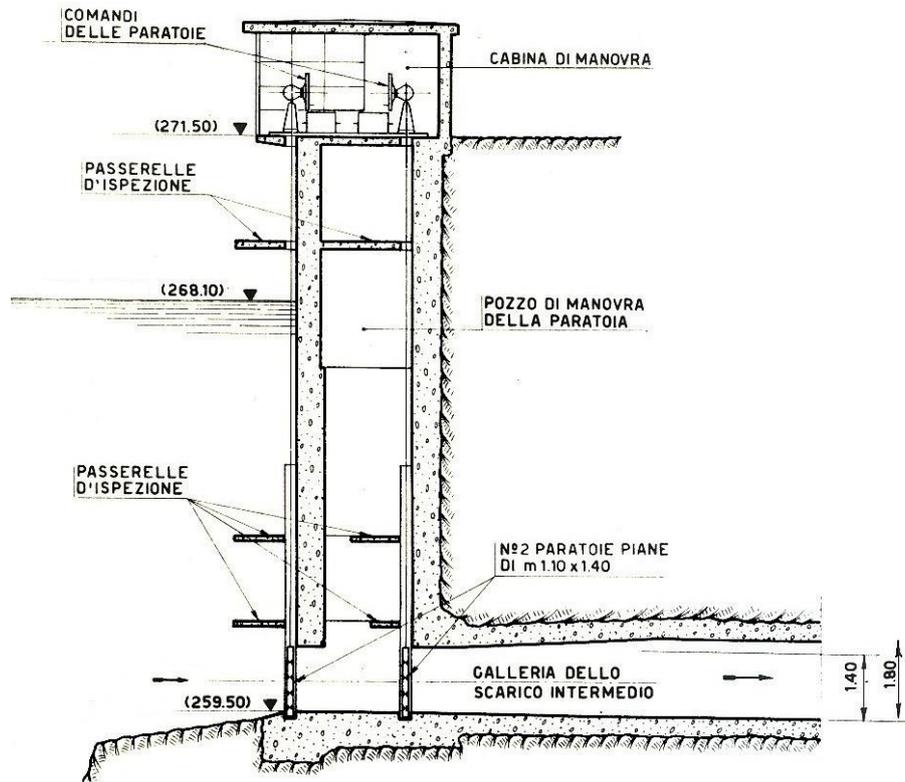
Sezione longitudinale imbocco scarico di mezzofondo
